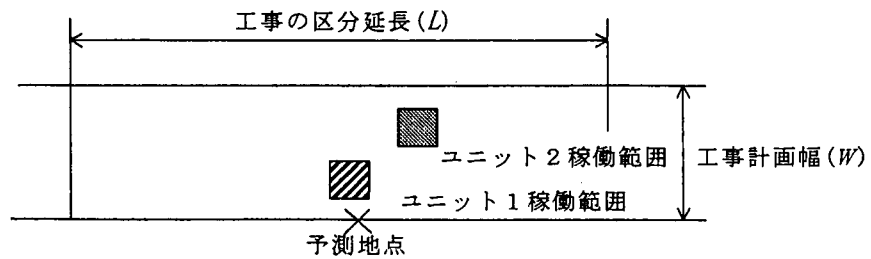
施工範囲が特定されない場合の施工範囲の配置例
